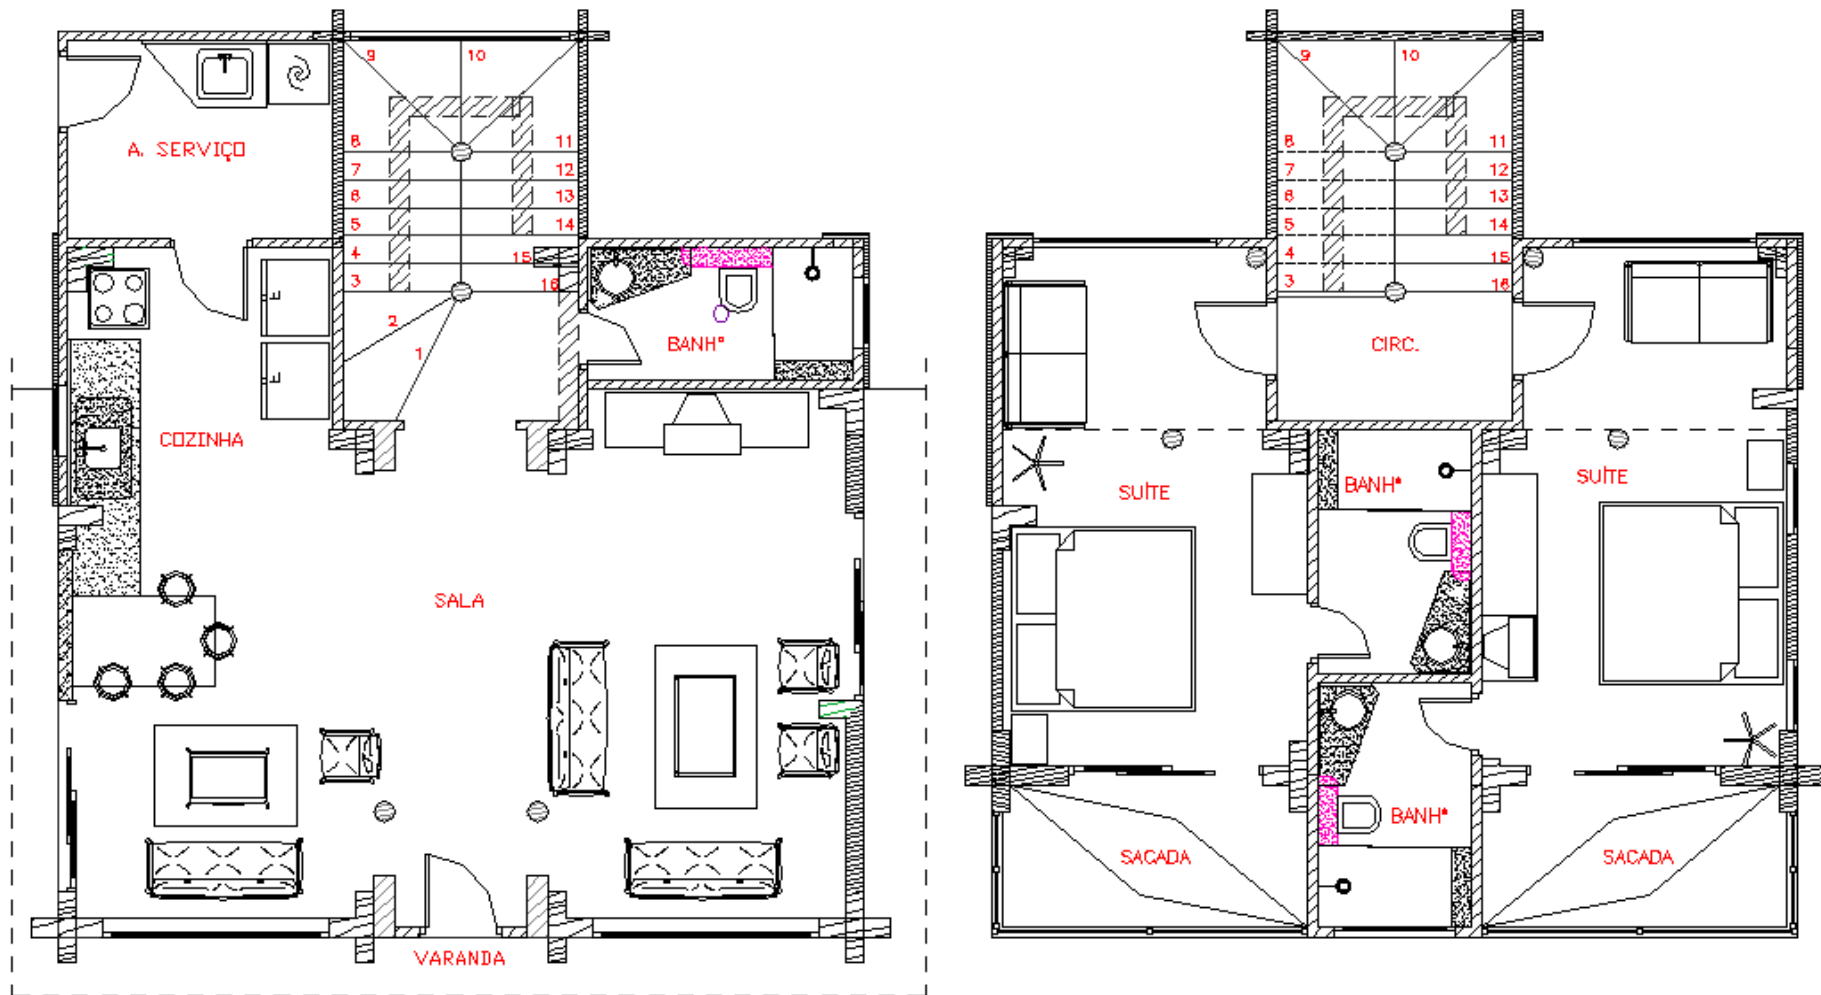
Planta baixa térreo dos dois pavimentos, à térreo e à esquerda pavimento superior. Projeto cedido pelo proprietário.
